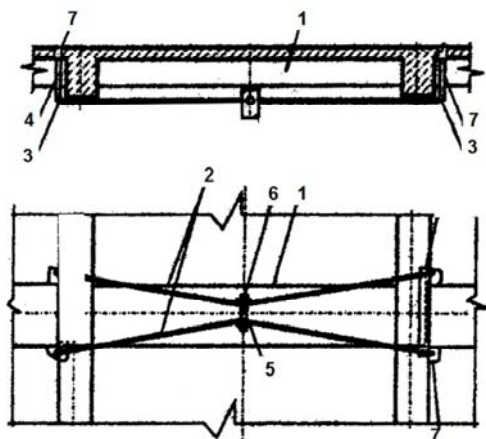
Усиление балки дополнительной предварительно напряженной арматурой (горизонтальные затяжки):
